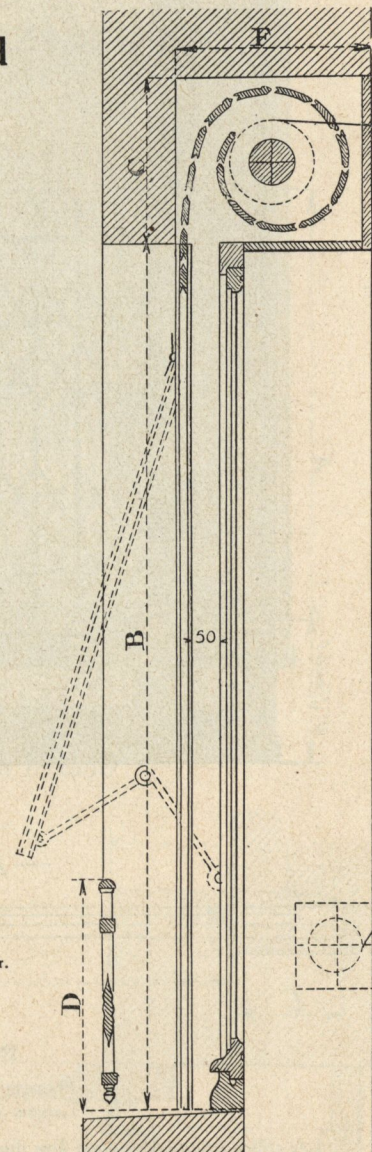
ENROULEMENT INTÉRIEUR sous l'arrière-couverte, tirage par sangle avec enrouleur.
